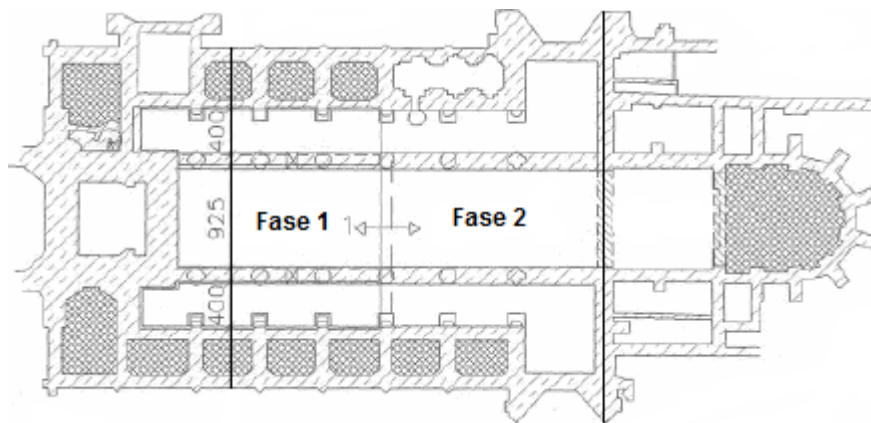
Planta da basílica, com as fases de escavação [51]
